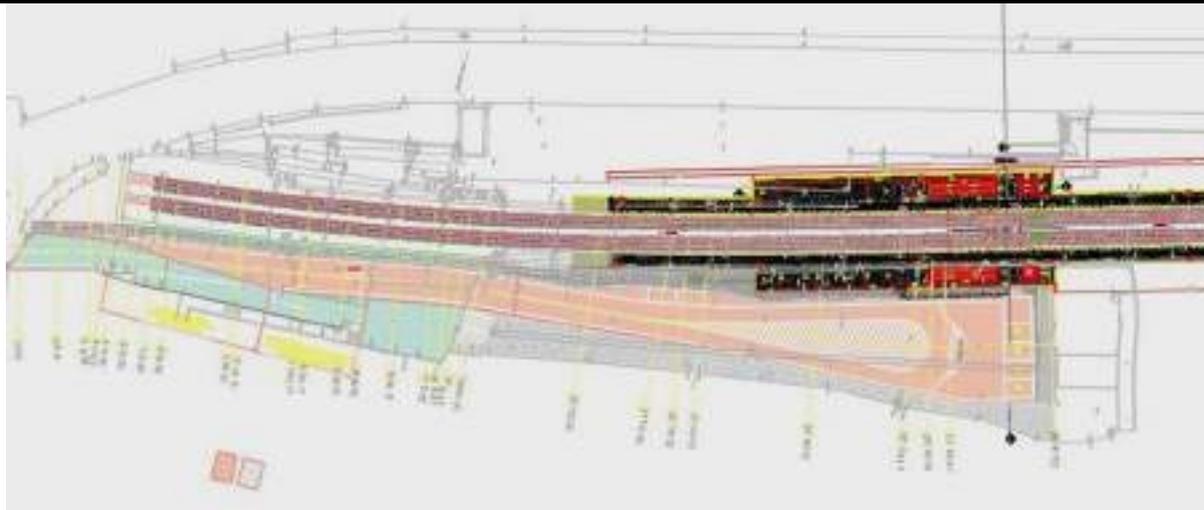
Planimetria di progetto Viabilità di accesso e piazzale
